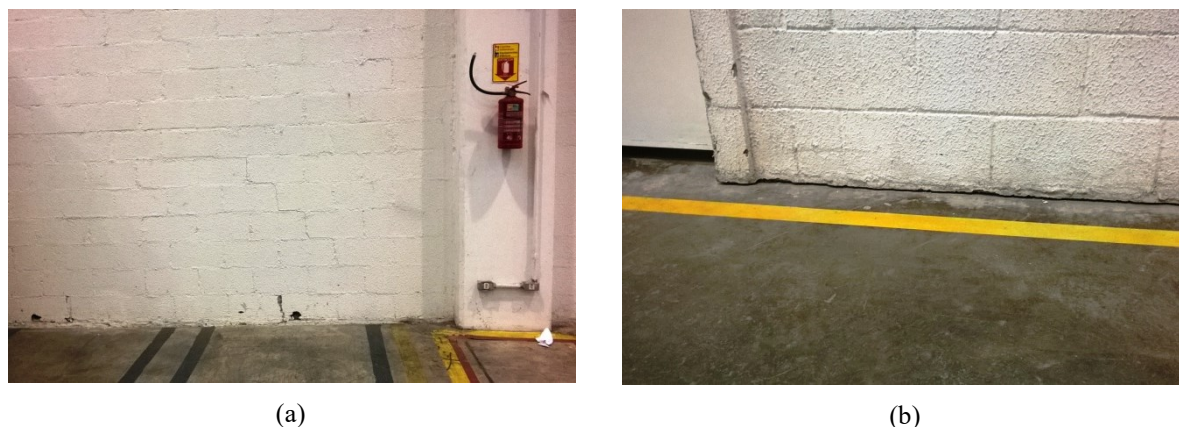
Recalque de placa. Em (a) ocorreu fissuração (diagonal) da alvenaria apoiada sobre a placa; em (b) a placa separou-se da alvenaria, criando abertura no encontro entre piso e parede
